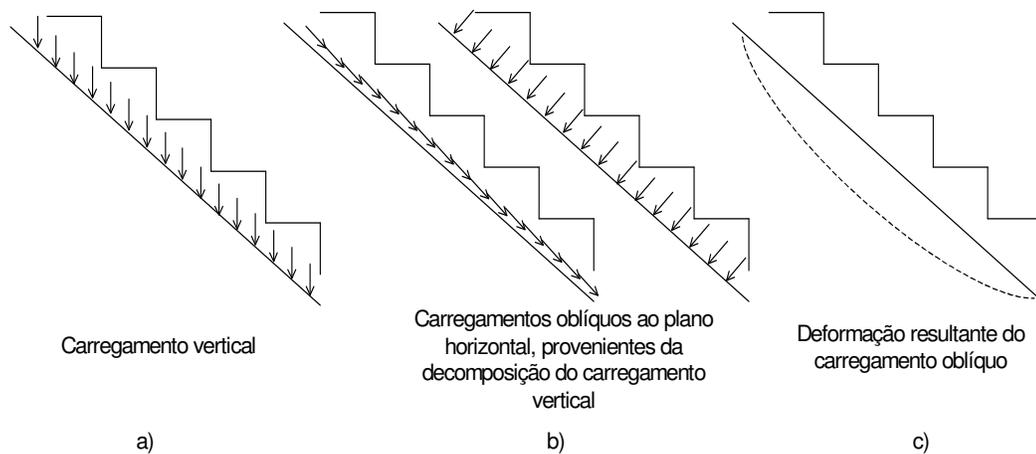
Representação esquemática das fôrmas de escada: a) carregamentos; b) deformação.
